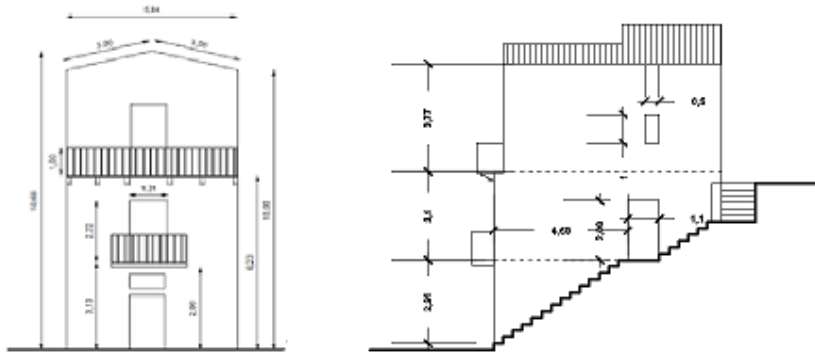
prospetto est dell'edificio e sezione dell'edificio
